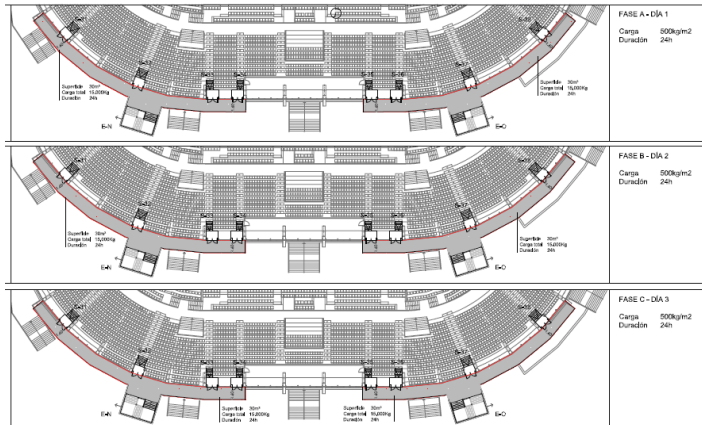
Plano Detalle Fases de Prueba de Carga de las Pasarelas Metálicas.
